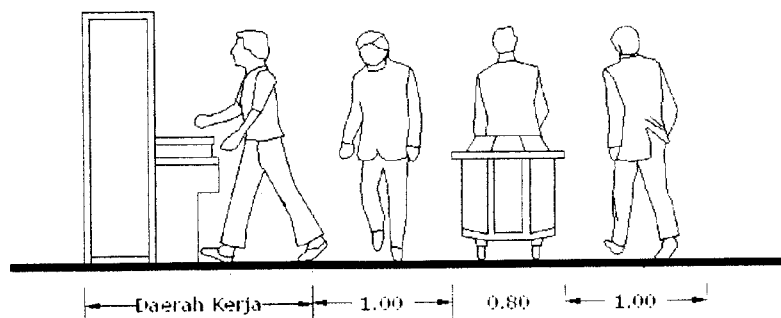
Kebutuhan Ruang Gerak Berjalan Membawa Barang
